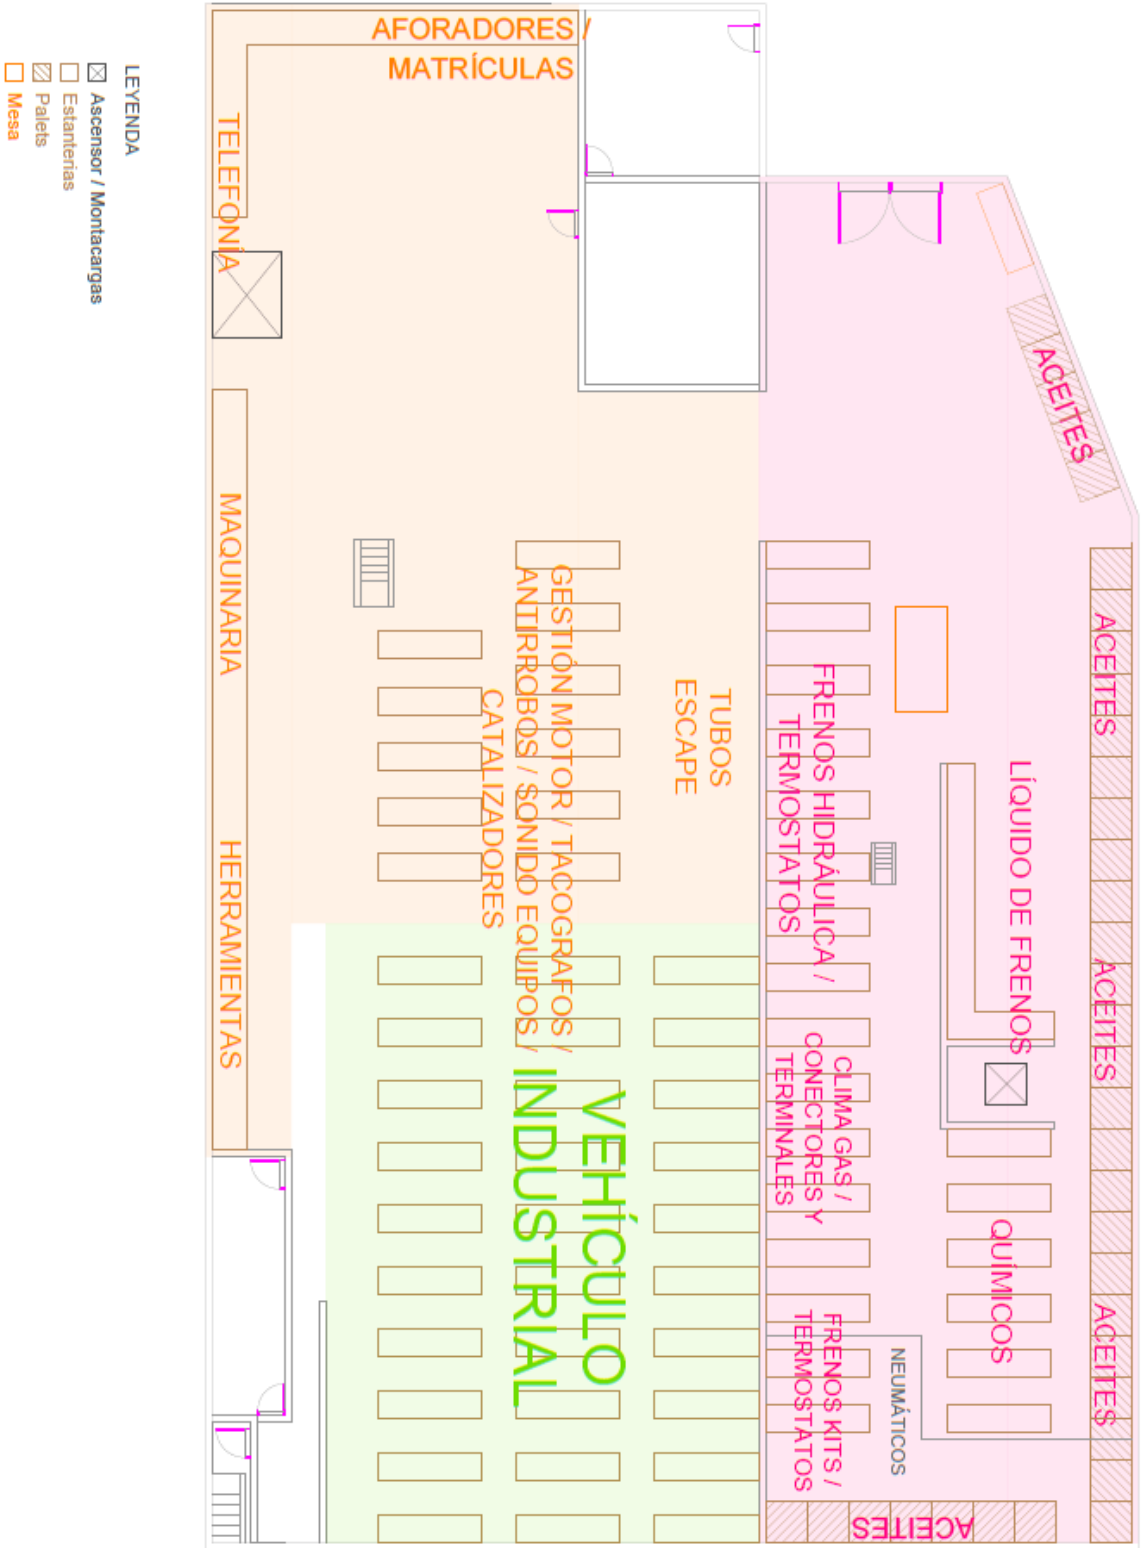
Imagen del plano situación de piezas segunda planta (Anexo D: P008)
